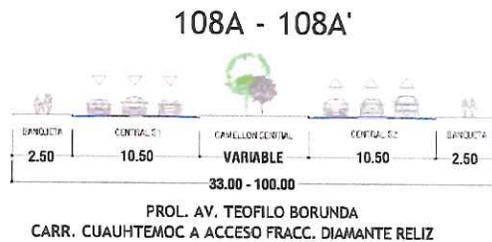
Sección vial existente Av. Teófilo Borunda.<sup>71</sup>
